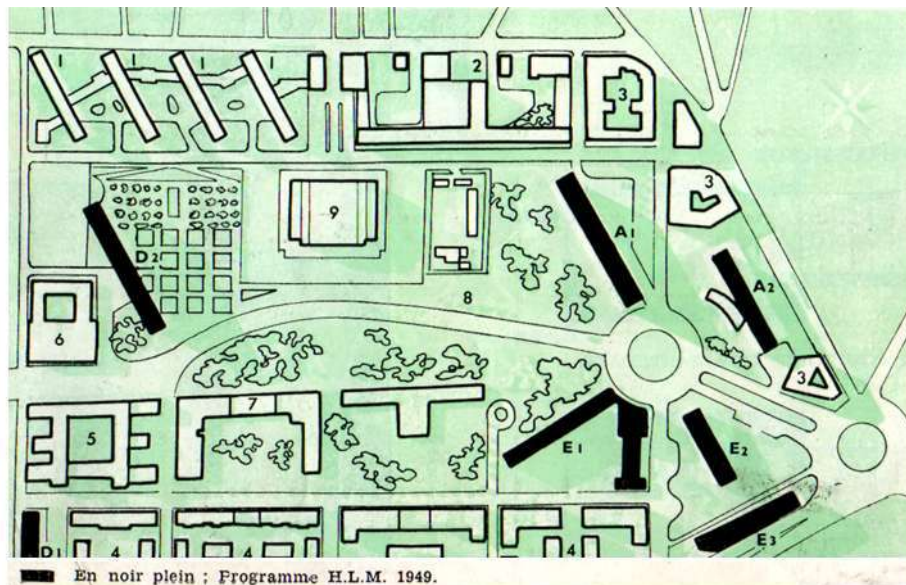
Plan de masse du groupe Champ de Manœuvres, Alger, 1949.
